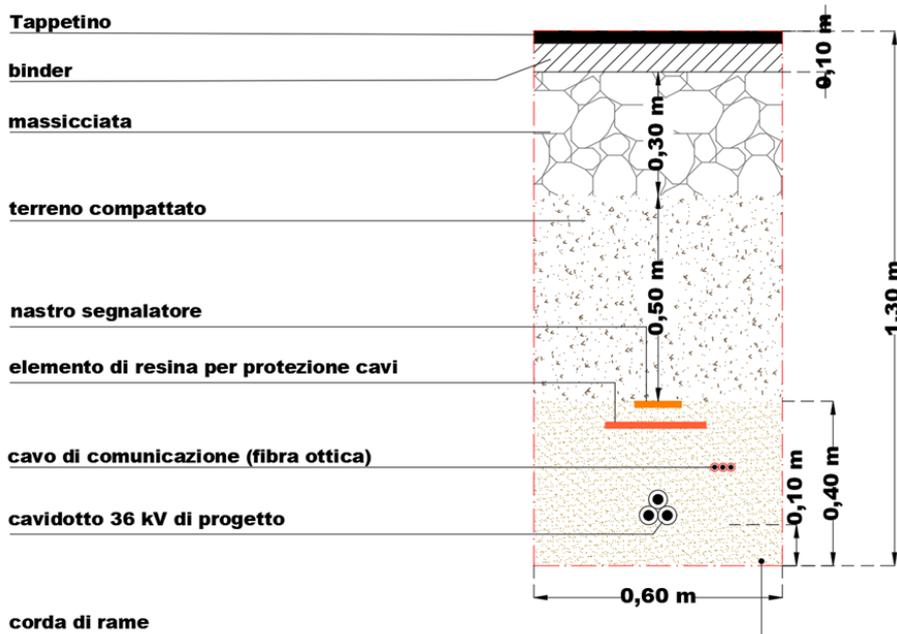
Sezione Cavidotto singola terna di cavi su Strada Asfaltata
